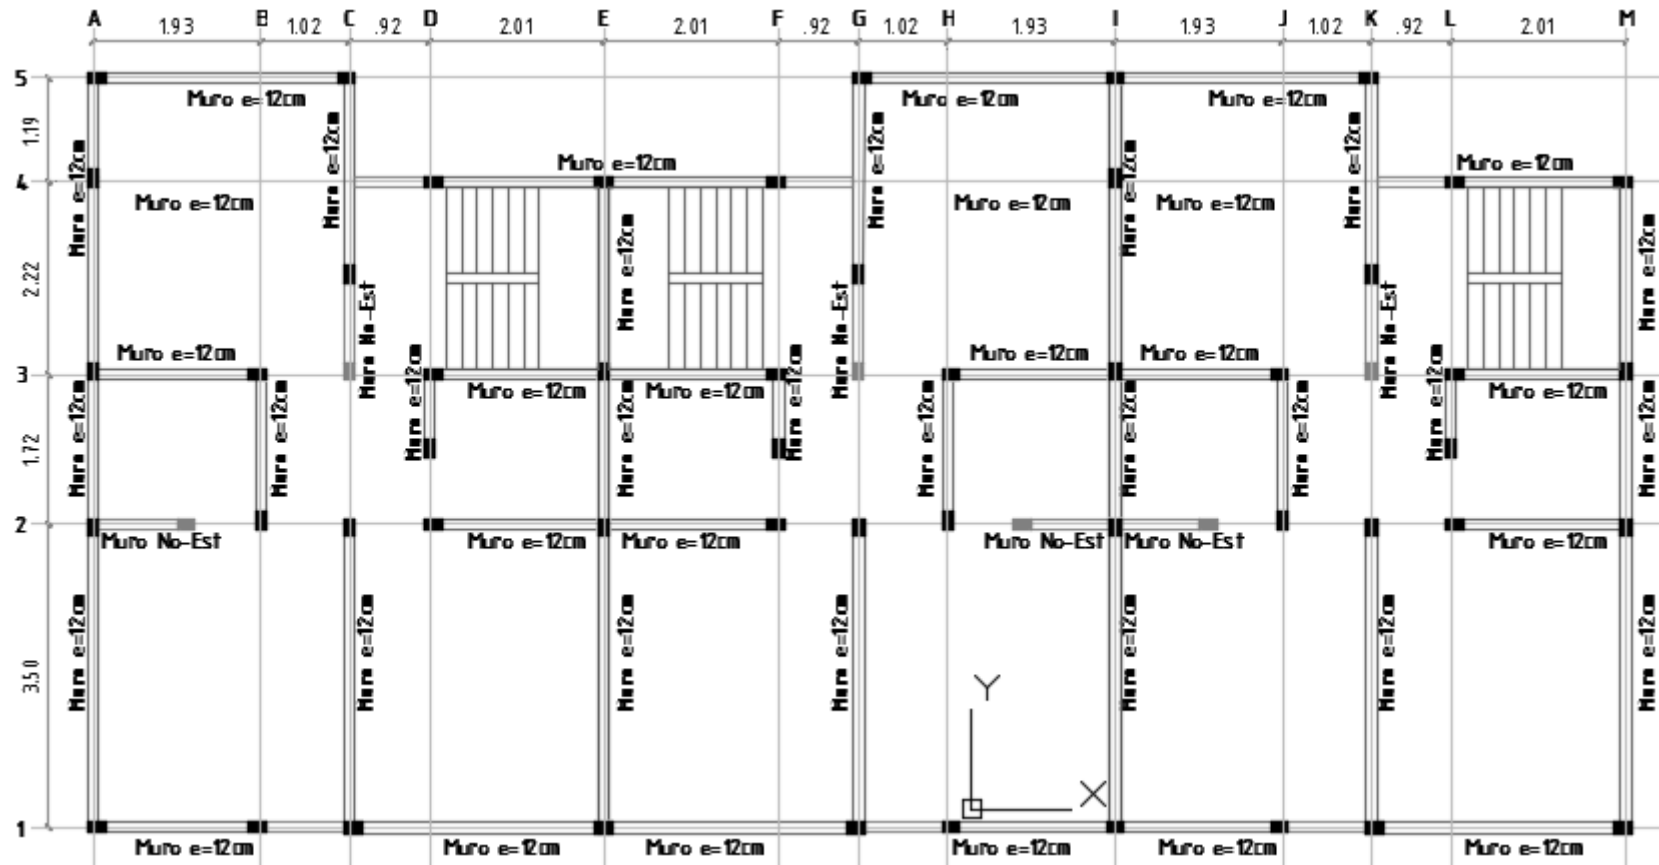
Replanteo estructural muros de mampostería confinada, segundo piso
